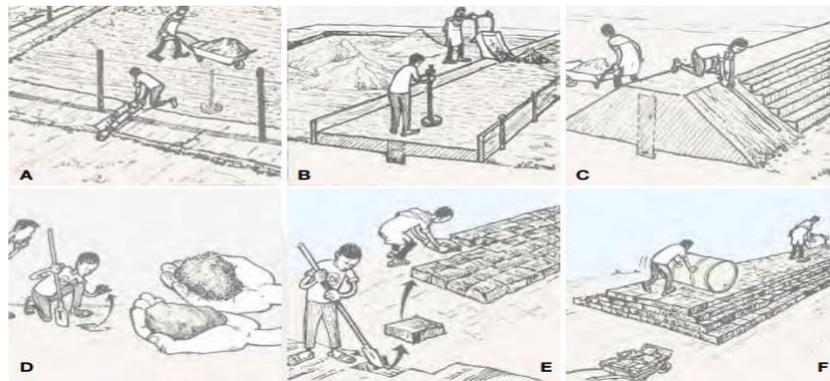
Construction de digues (I). A, B et C : Traditionnel ; D, E et F : construction en blocs (Anton Lamboj, (2008).
